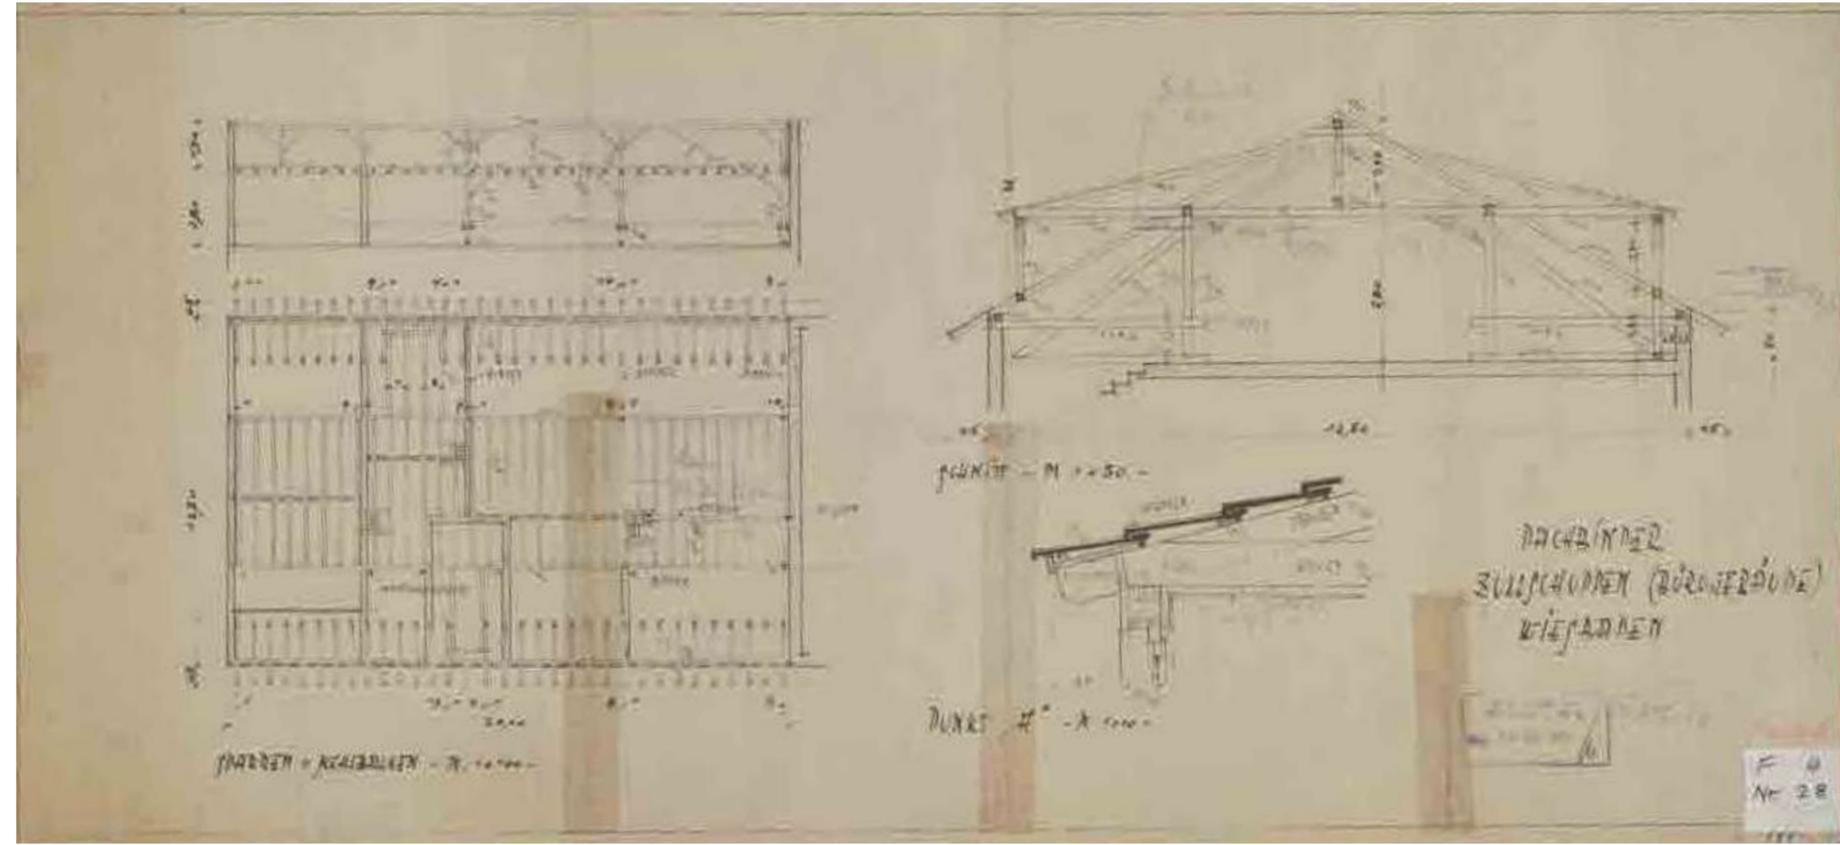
Zollabfertigung: Plan der neuen Dachbinderkonstruktion, 1951
